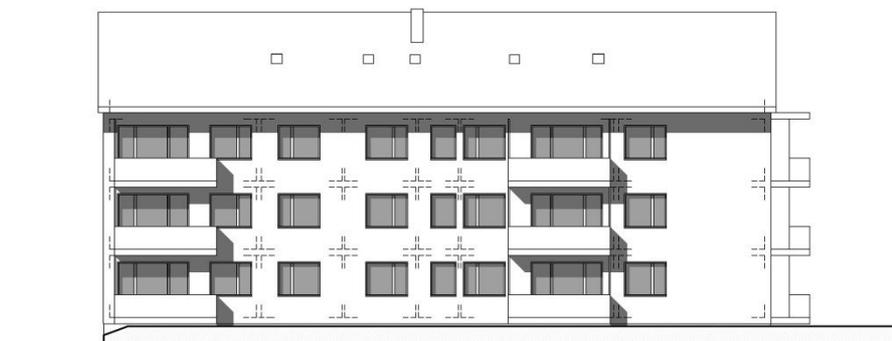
Fallbeispiel, Plan Nordwest-Fassade
